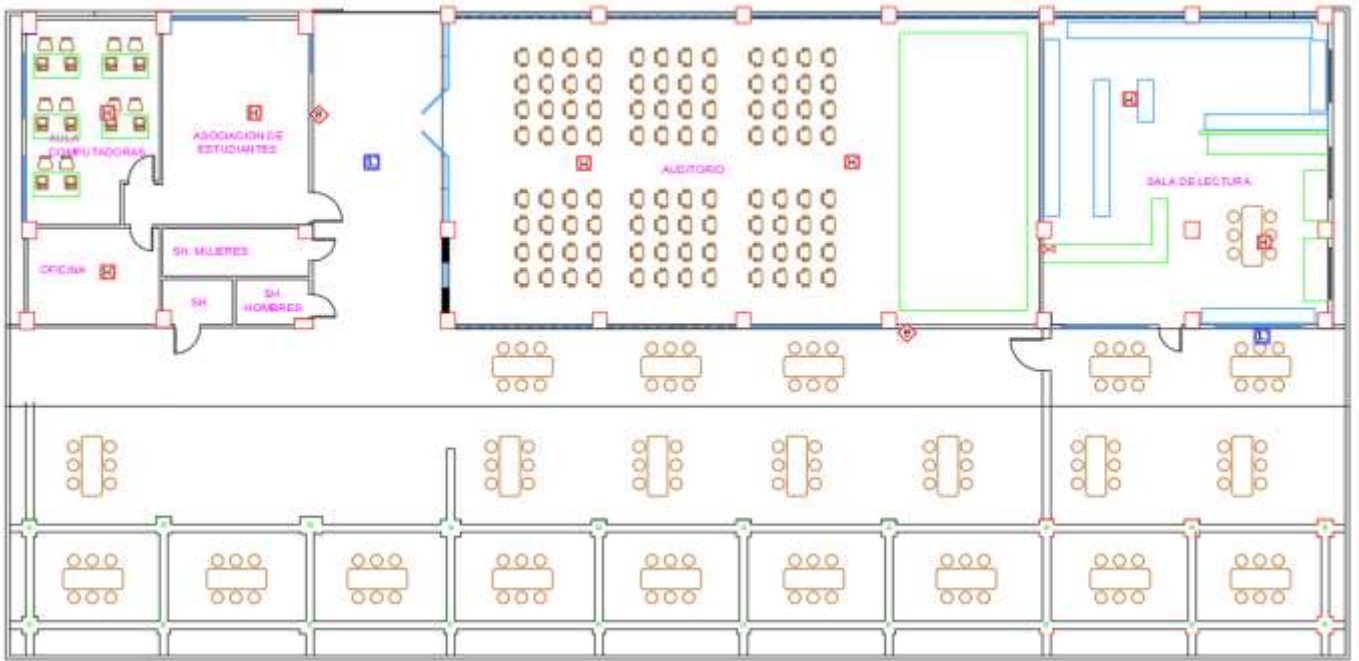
Segundo Piso – Plano Arquitectónico. Fuente: (Coordinación Académica)
